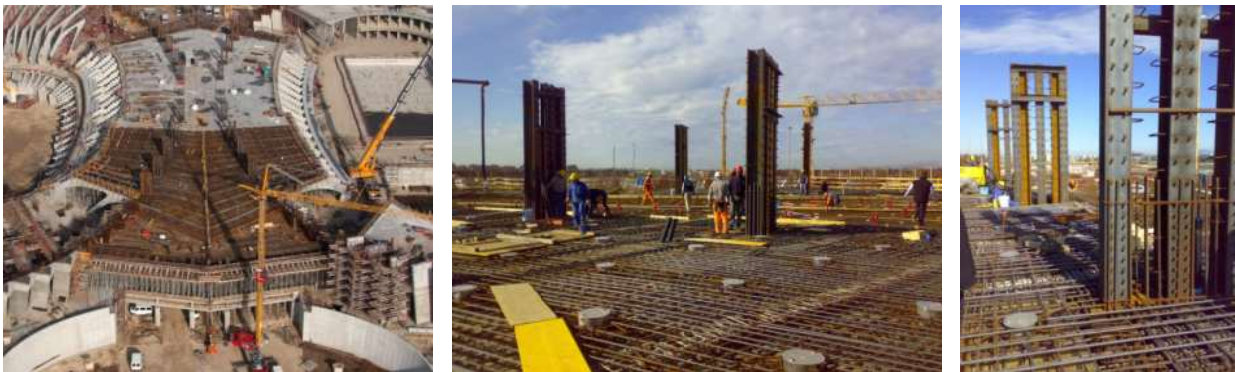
Setti zona foyer: vista aerea del solaio q.ta 8.0 e spiccato dei profilati di armatura dei setti
